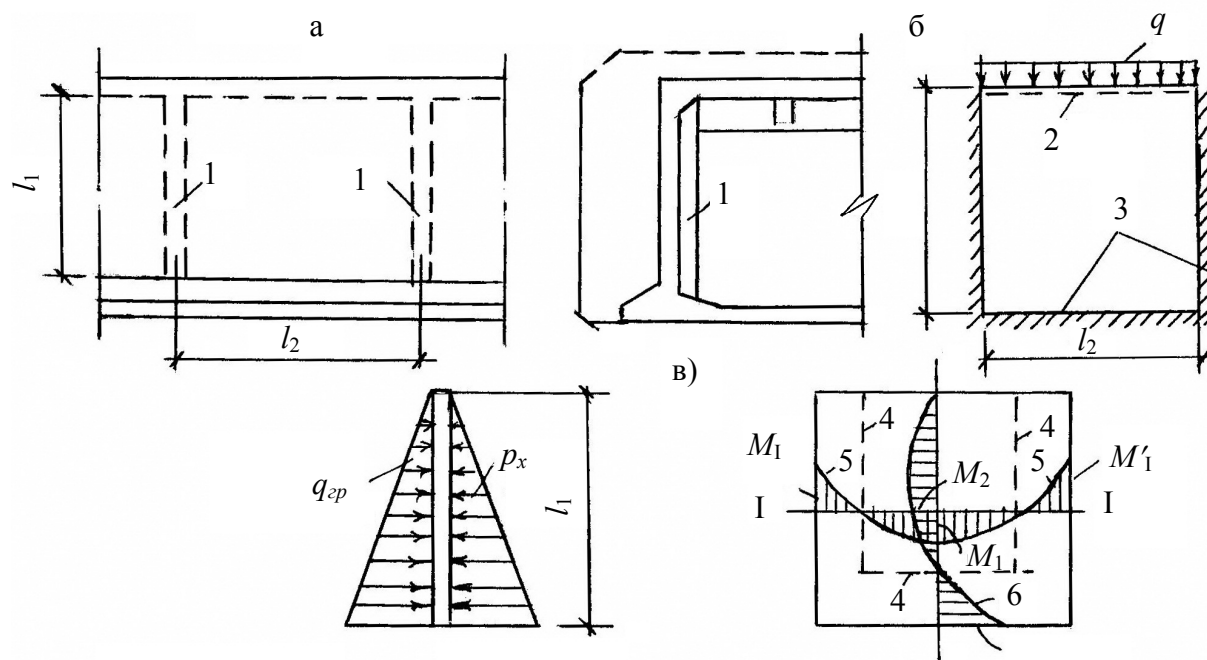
Расчет стены прямоугольного резервуара как плиты, опирающейся по контуру: а – конструктивна схема; б – расчетная схема; в – эпюры моментов; 1 – вертикальное ребро; 2 – шарнирное опирание; 3 – защемление; 4 – линии нулевых моментов; 5 – эпюра изгибающих моментов вдоль пролета  $l_2$ ; 6 – то же самое вдоль пролета  $l_1$ ;  $p_x$  – гидростатическое давление воды;  $q_{ep}$  – давление грунта;  $q$  – давление от покрытия
